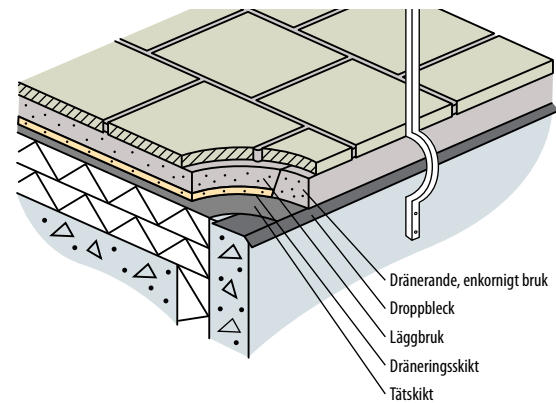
Typkonstruktion AT. Uppbyggnad av altan på betongbjälklag.
